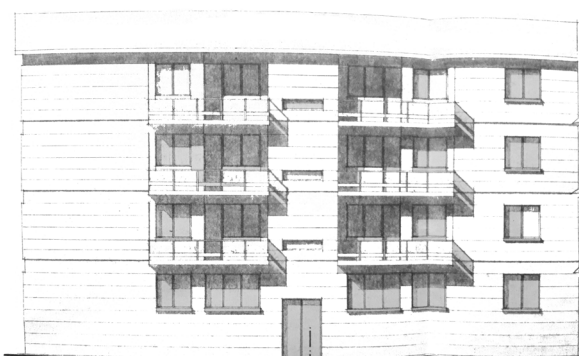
Plano del alzado Este (fachada frontal) del edificio ubicado en la Rúa Vilagarcía-Arousa, 6 (fotografía de autoría propia).
